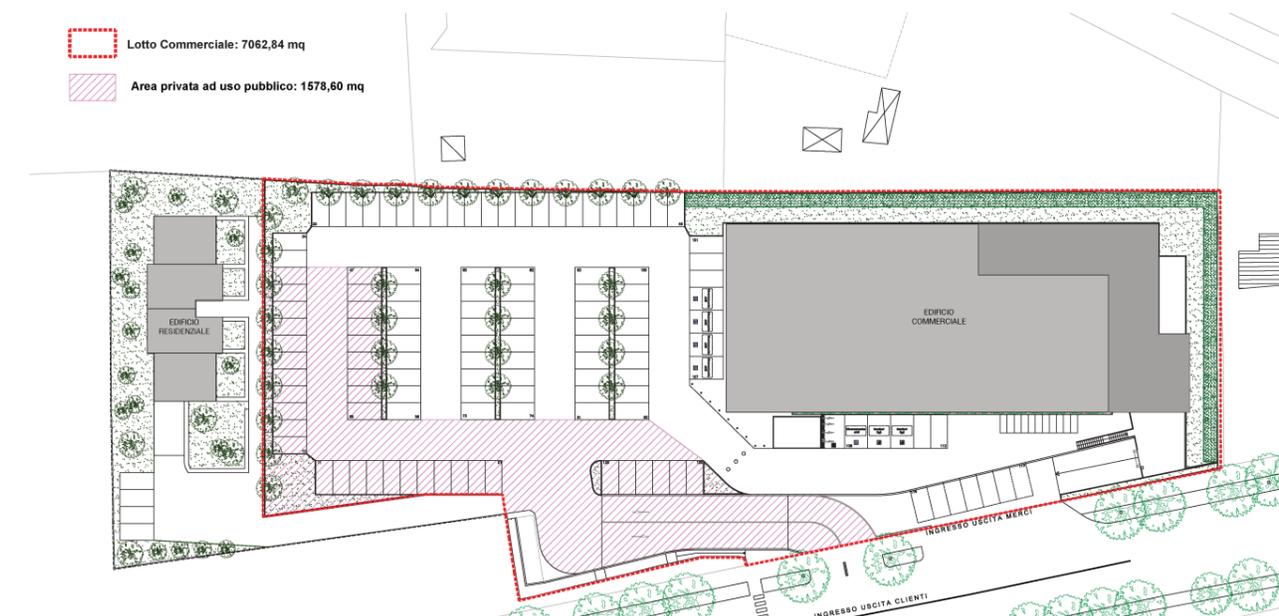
Planimetria del Piano Attuativo con l'area privata a uso pubblico
